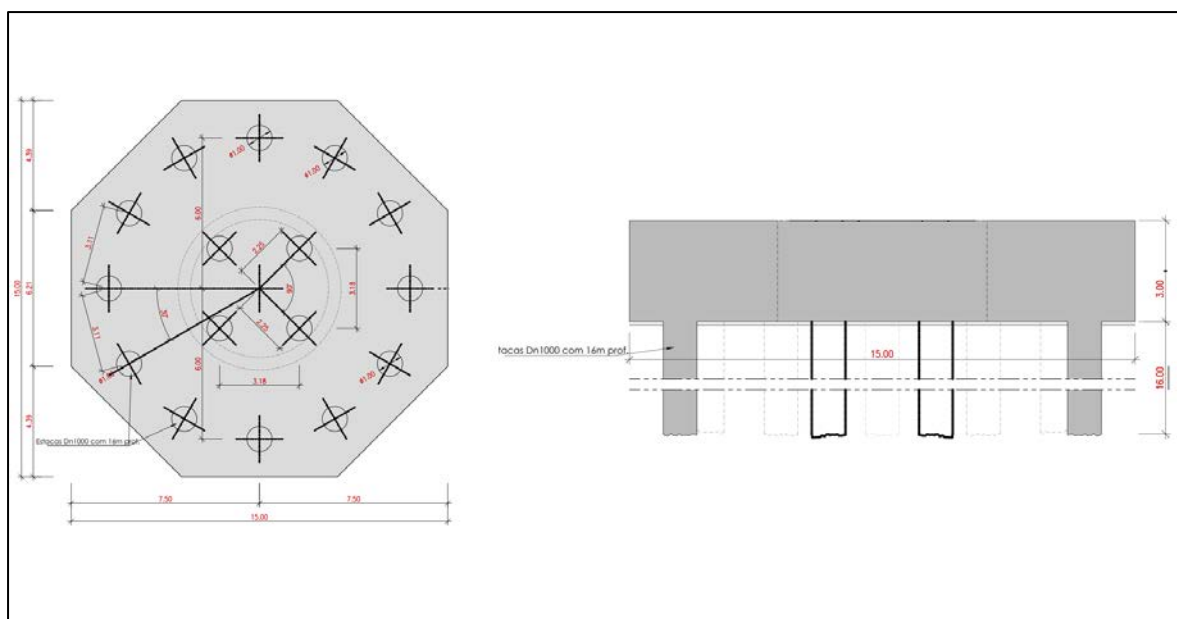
Diagrama da fundação do reservatório elevado. Esquerda: secção transversal da laje de base em betão com a disposição das estacas de betão. Direita: perfil lateral da laje de betão e das estacas (Fonte: GRINER, 2025, adaptado pela Dar, 2025).
